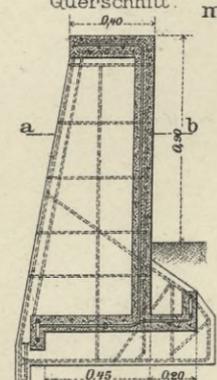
^c Grundriss. Schnitt nach a-b.
